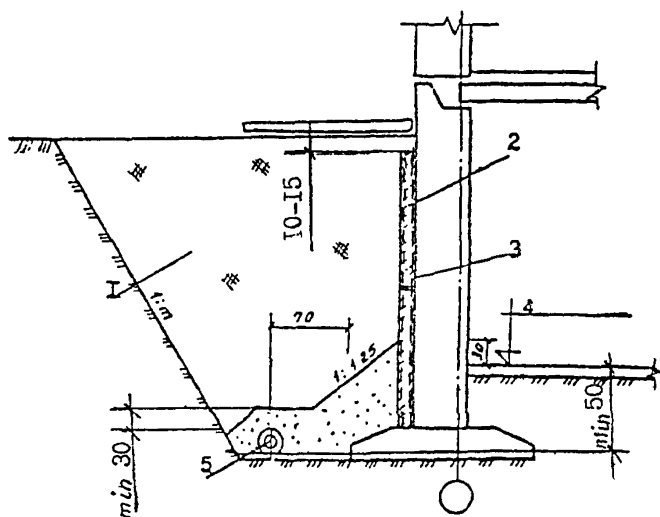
Схема пристенного дренажа здания с сопутствующим дренажом:
